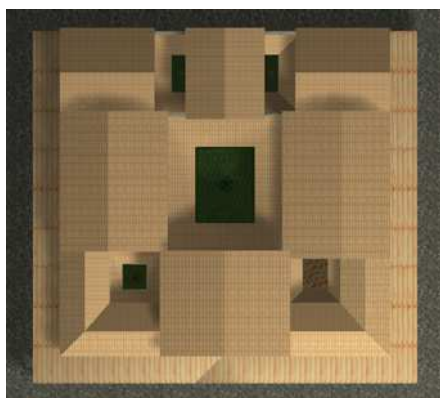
y 130. Planta y fachada ¾ del exterior de la Casa de los Pájaros.
